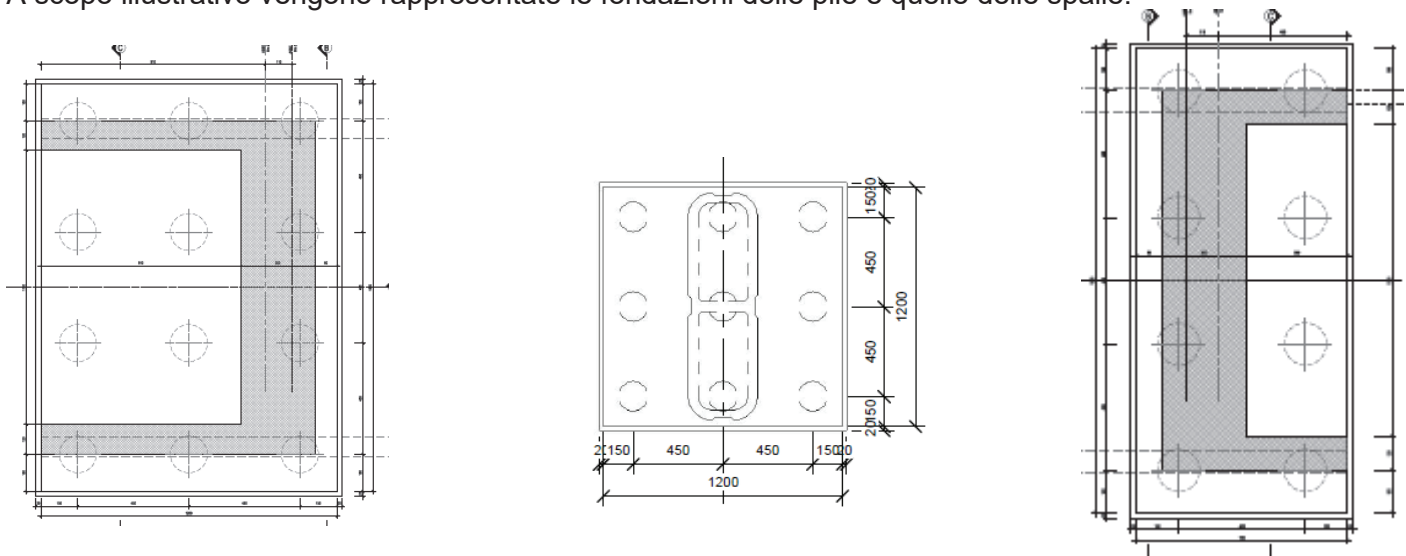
Pianta delle fondazioni delle pile e delle spalle
